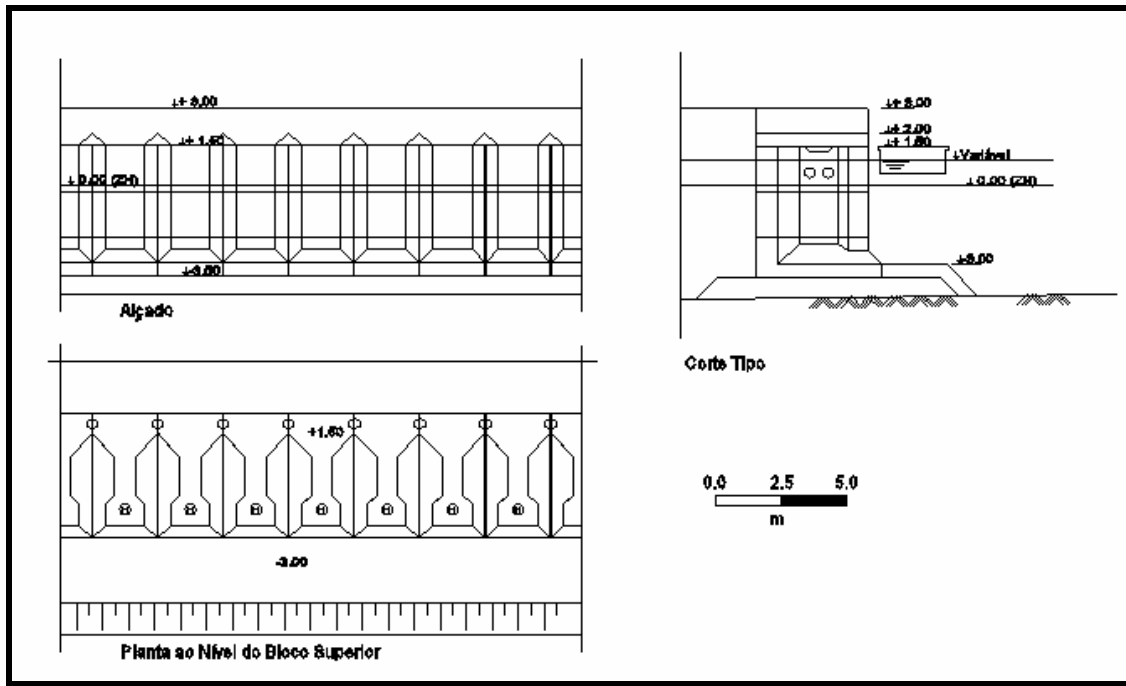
Cais de Recepção – Passadiço flutuante aderente a um cais em blocos NOREF
